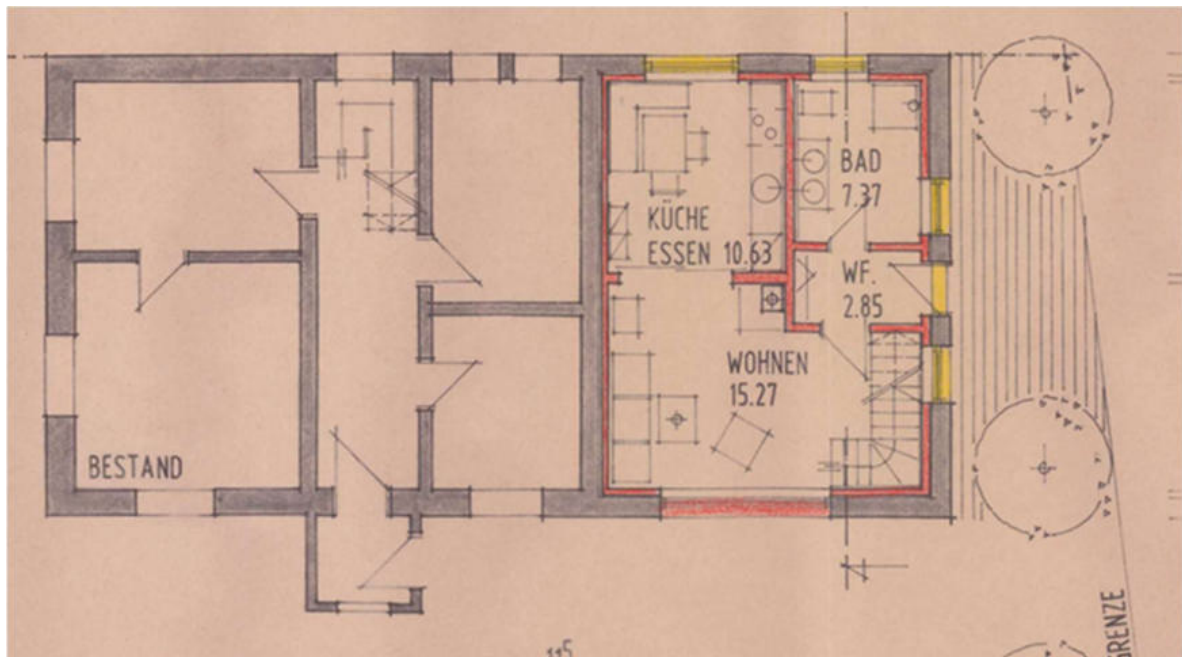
Grundriss Erdgeschoss (Umbau Scheune zu Wohnhaus 1993)
